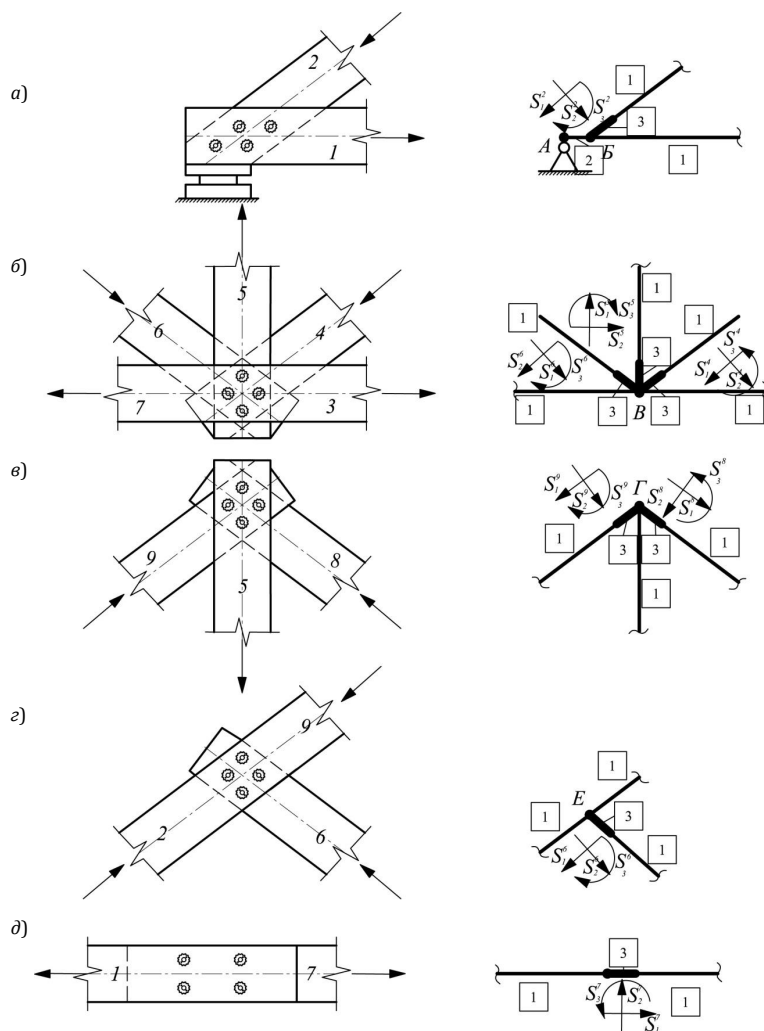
Схемы к расчету соединений в конструкциях ферм с обозначением номеров стержней и принятых типов конечных элементов (в квадратах): а – узел соединения верхнего и нижнего пояса; б – узел соединения нижнего пояса, раскосов и стойки; в – узел соединения стойки и верхнего пояса; г – узел соединения верхнего пояса и раскоса; д – узел соединения элементов по длине
